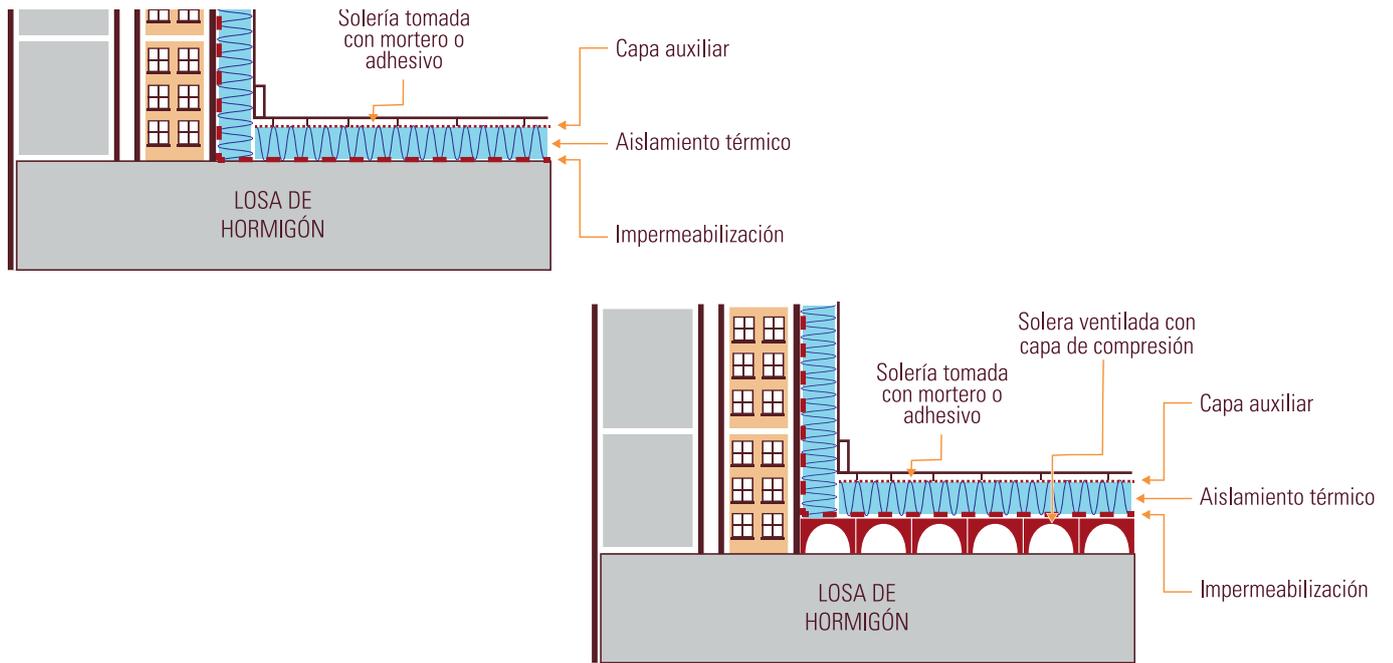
Mejora del aislamiento en losa de cimentación mediante solera ventilada
